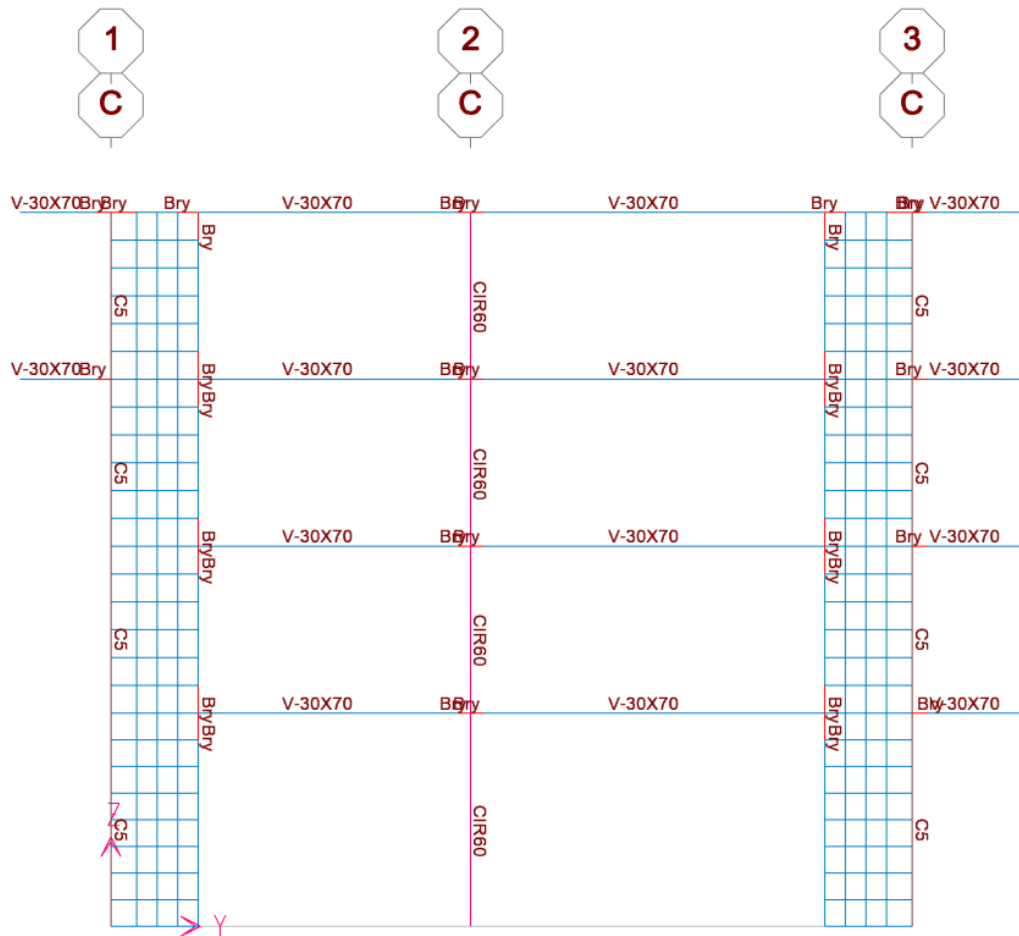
Elevación del eje C muestra la conexión viga con muro de corte
